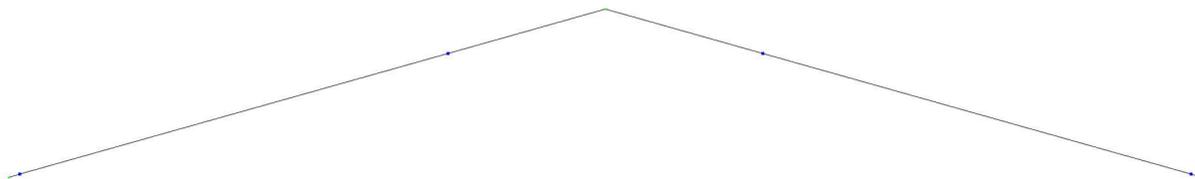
Конечно-элементная расчетная схема покрытия
